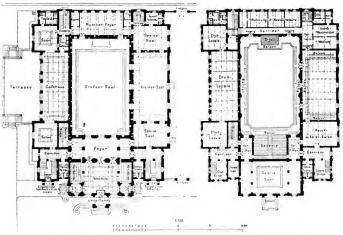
Grundriss des Ebenerdgeschoßes.
